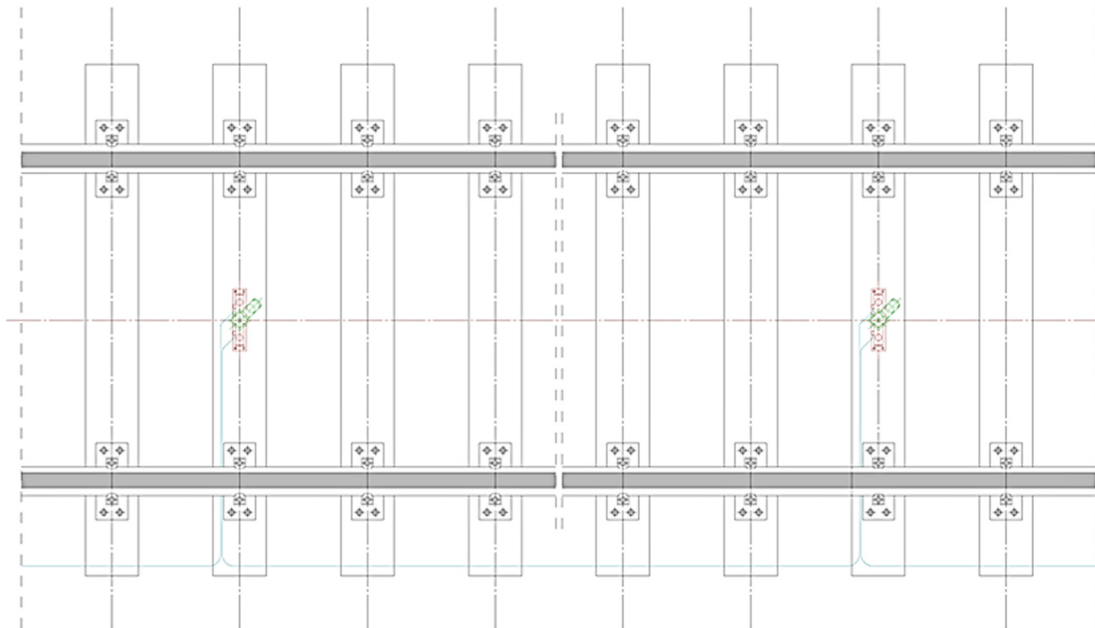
Sistemi di monitoraggio – Stralcio planimetrico
